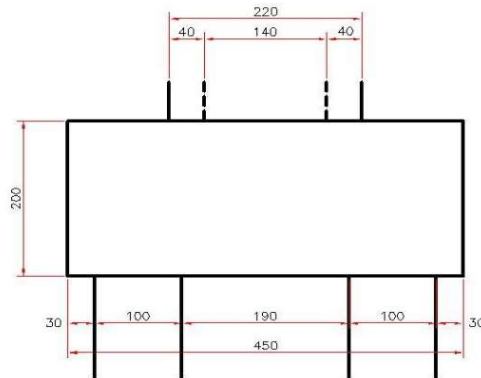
Sección geométrica de la zapata (Fuente: especificaciones generales del proyecto)
